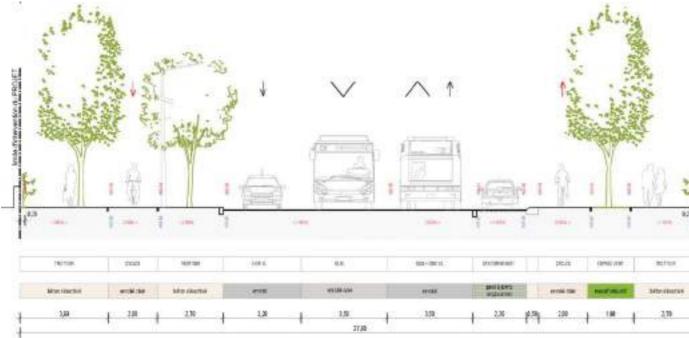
Profil futur de l'Avenue Bollée - Nord
